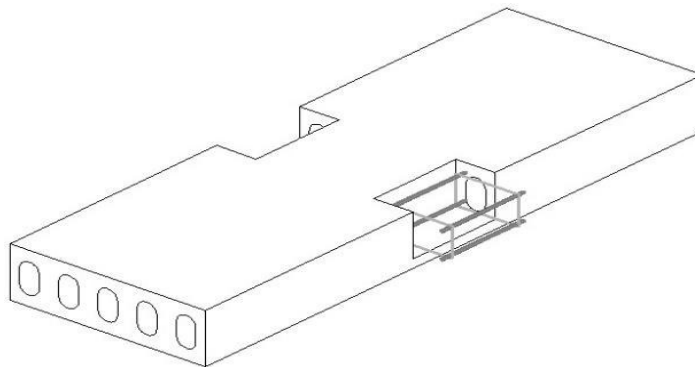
Alternativa de ligação entre lajes alveolares (Magalhães, 2013).
